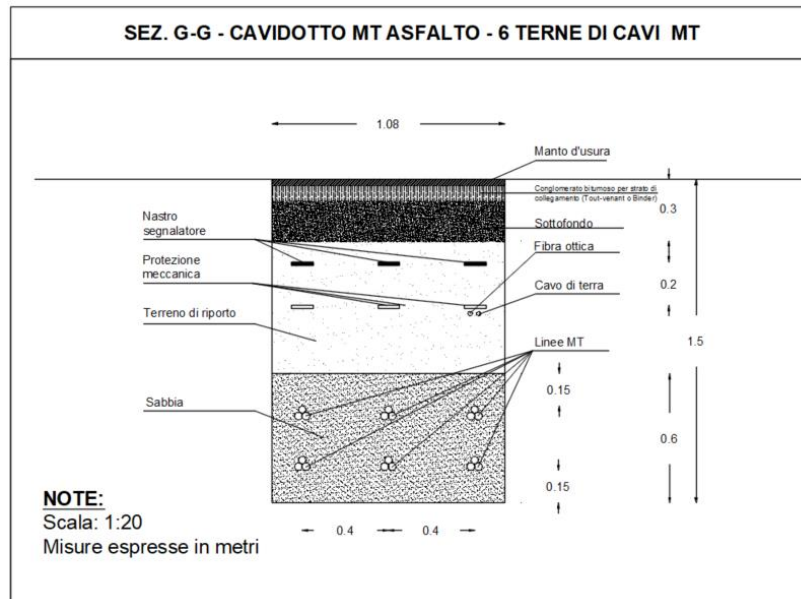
Stralcio elaborato “FOM.ENG.TAV.031. _Planimetria dei cavidotti con indicazione delle sezioni di posa” – Sezioni per interrimento del cavidotto MT
